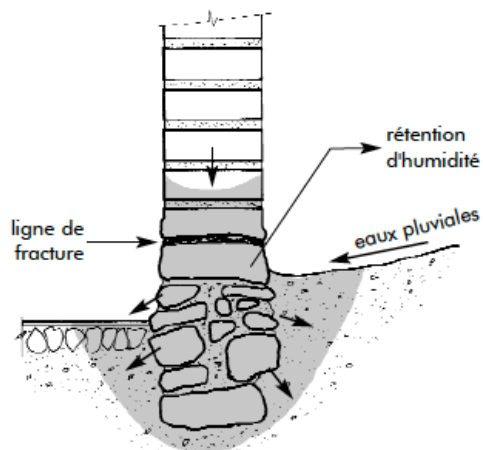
Exemple de détérioration d'un fondation dans un emplacement défavorable à cause de la pente du terrain qui conduit l'humidité sur le mur (Carazas, s.d.)
